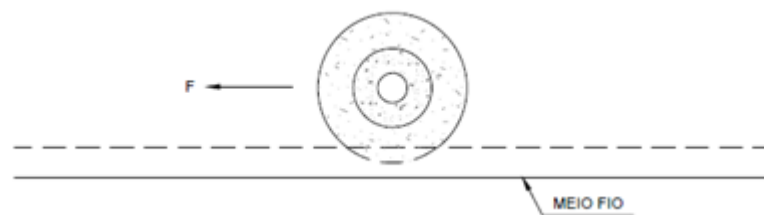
Engastamento de poste de concreto seção circular com base concretada
